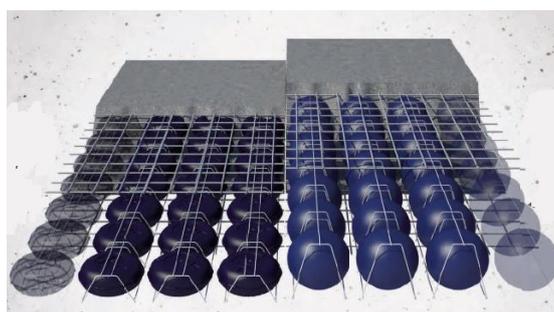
Конструктивные решения для облегченного железобетонного перекрытия
